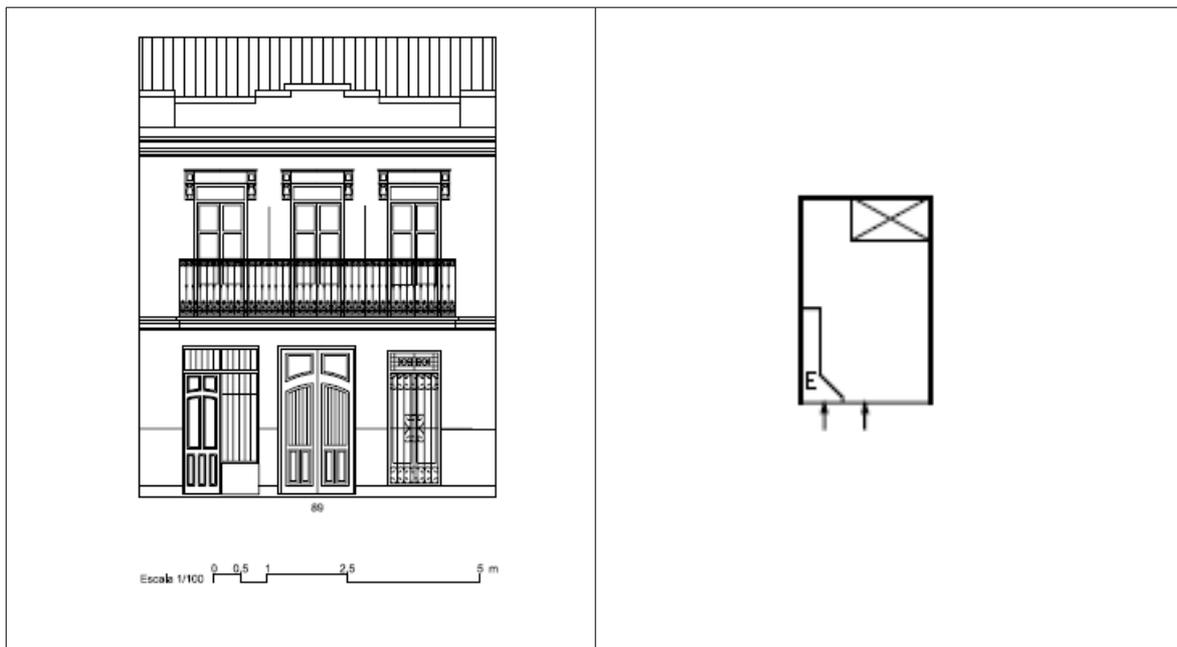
Tipo B1. Ejemplo de fachada y esquema de planta (ficha 324-16)
